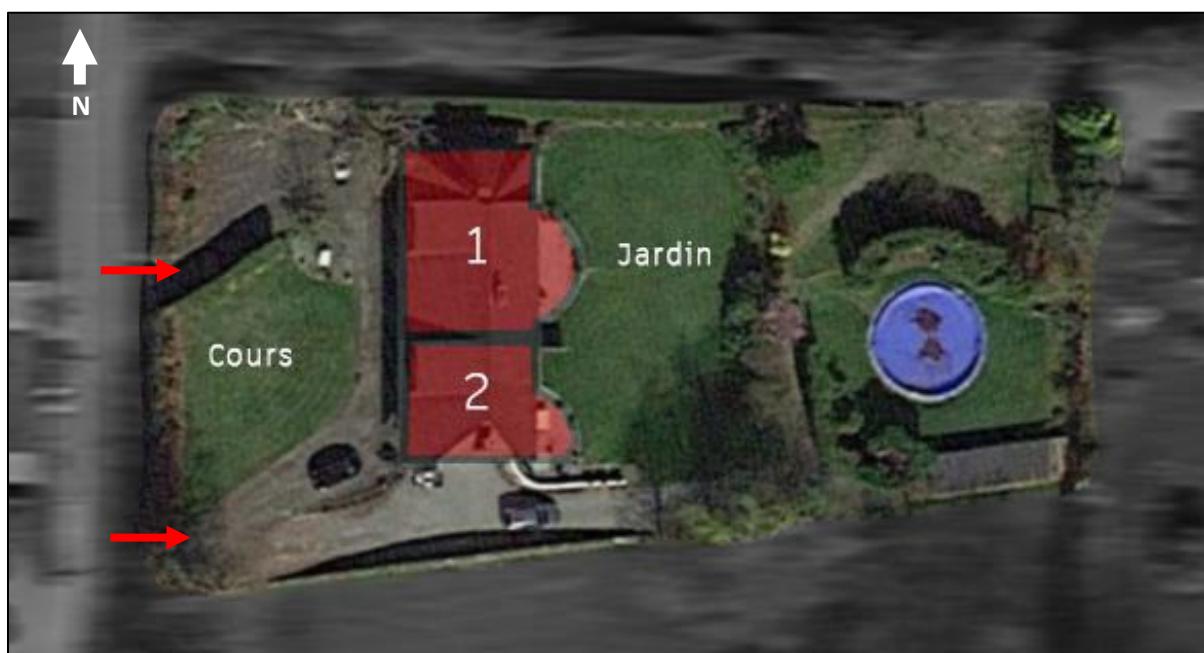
Schéma de situation cas 1 (Fond de plan Google Earth)
